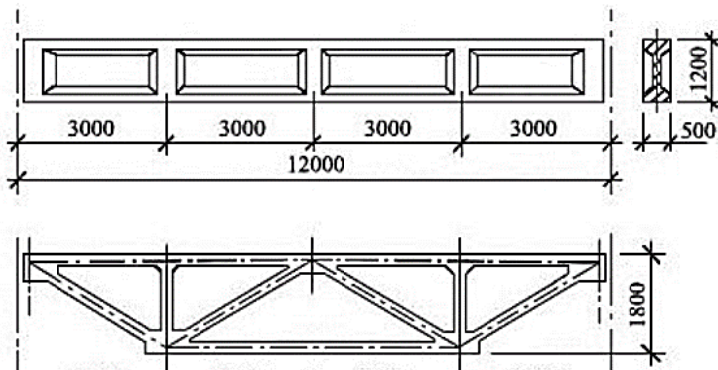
Продольная предварительно напряженная балка и ферма для покрытий из панелей-оболочек КЖС при шаге колонн 12 м
